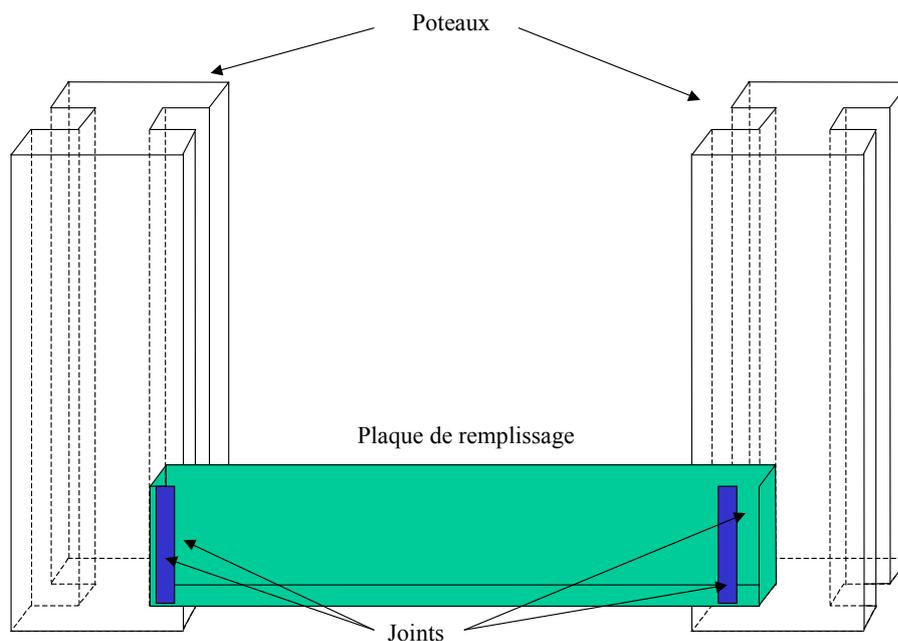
Schéma d'organisation d'un mur coupe-feu : mise en place des plaques de remplissage dans les poteaux.
